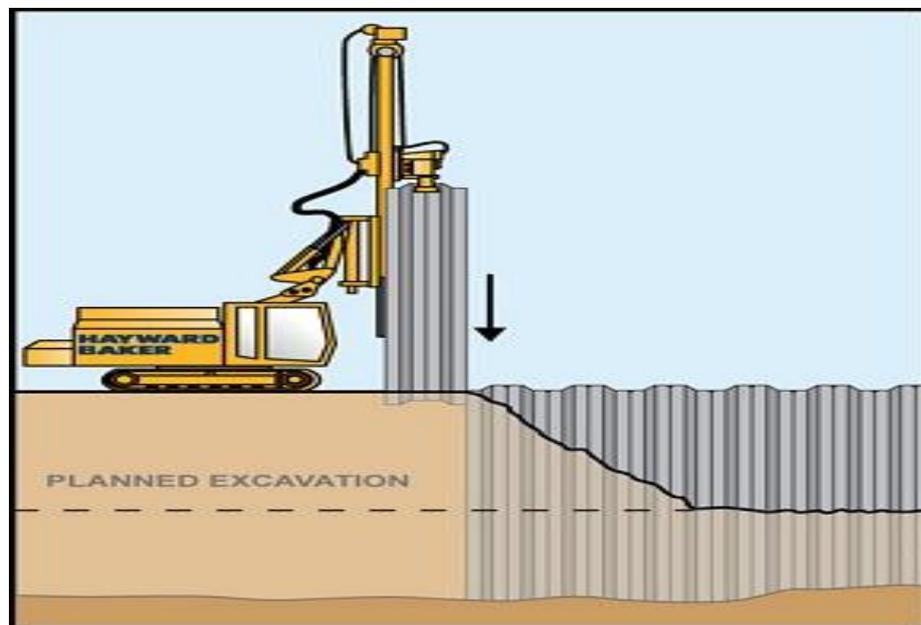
Dinding penahan cantilever (cantilever retaining wall)
